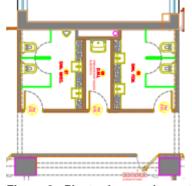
Planta de novo Layout - nova localização no Banheiro existente (2ºpavimento)
